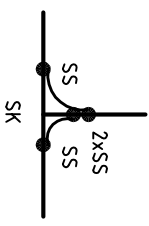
DETAIL KŘÍŽENÍ JÍMACÍHO VEDENÍ:
